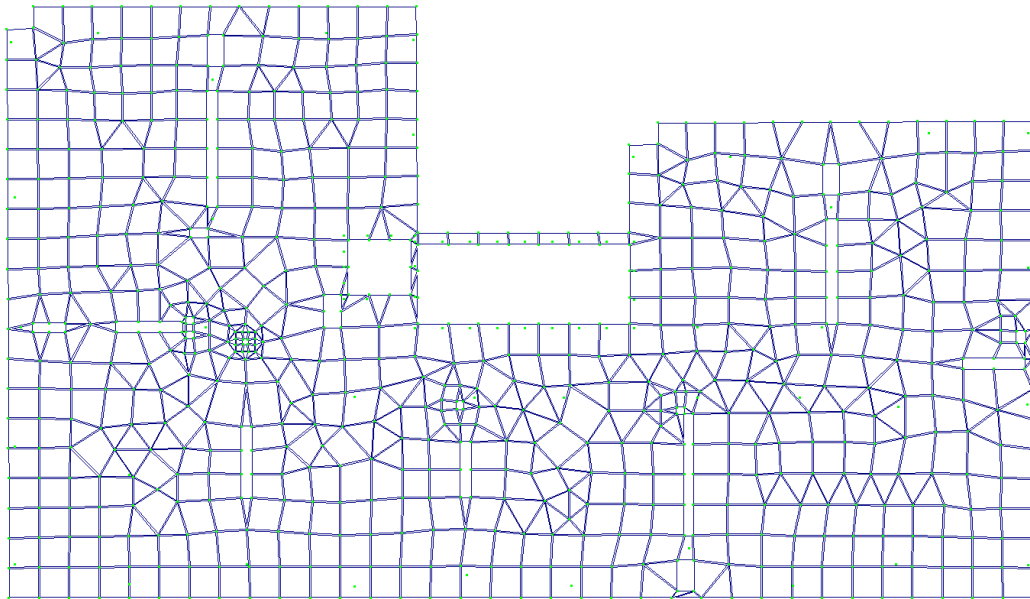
Зображення розрахункової схеми міжповерхового перекриття
